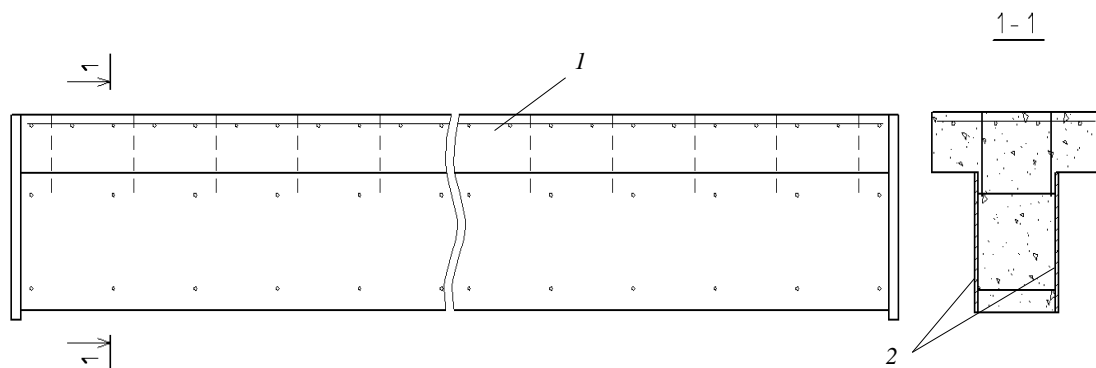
Сталезалізобетонна балка таврового перерізу
